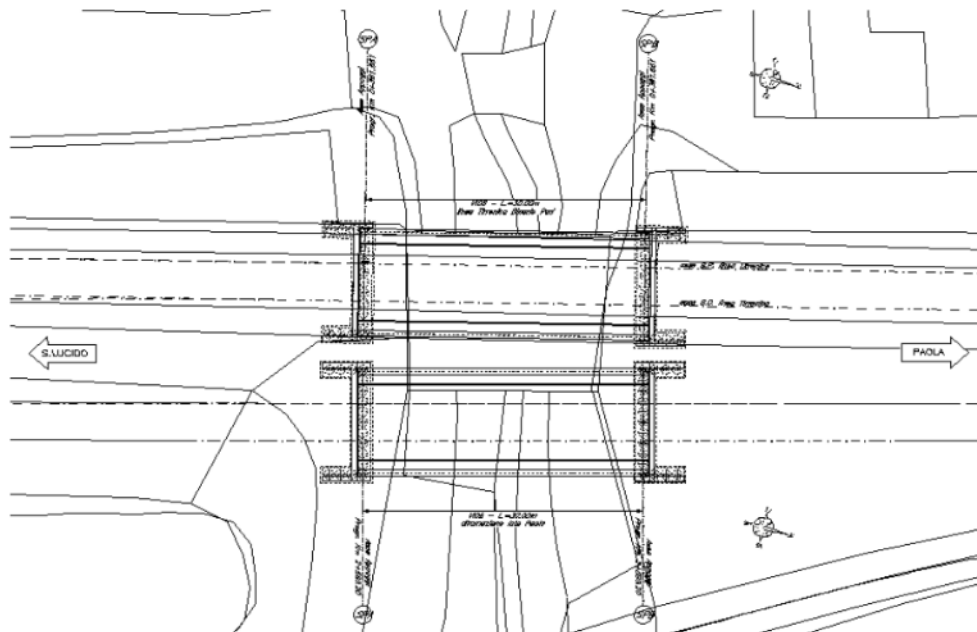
Planimetria dei viadotti ferroviari VI06a e VI06b
